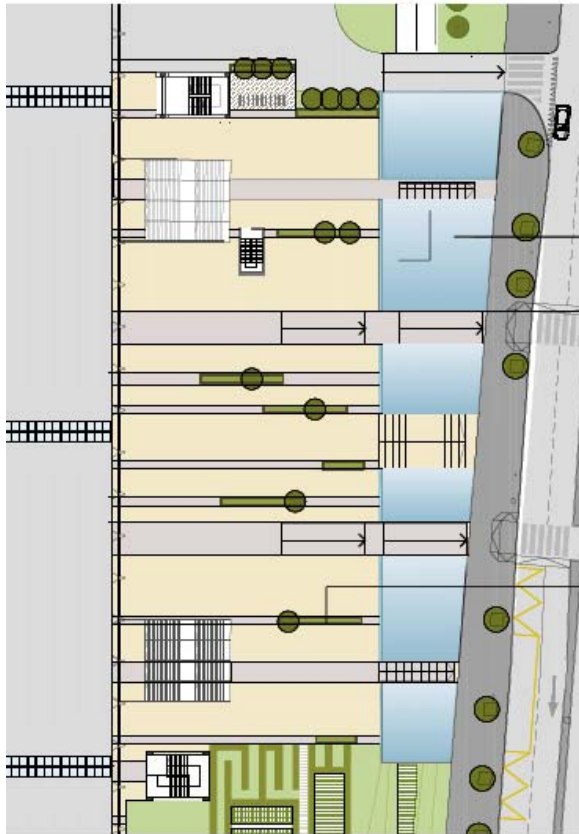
Progetto di riqualificazione – Piazza Ventimiglia
